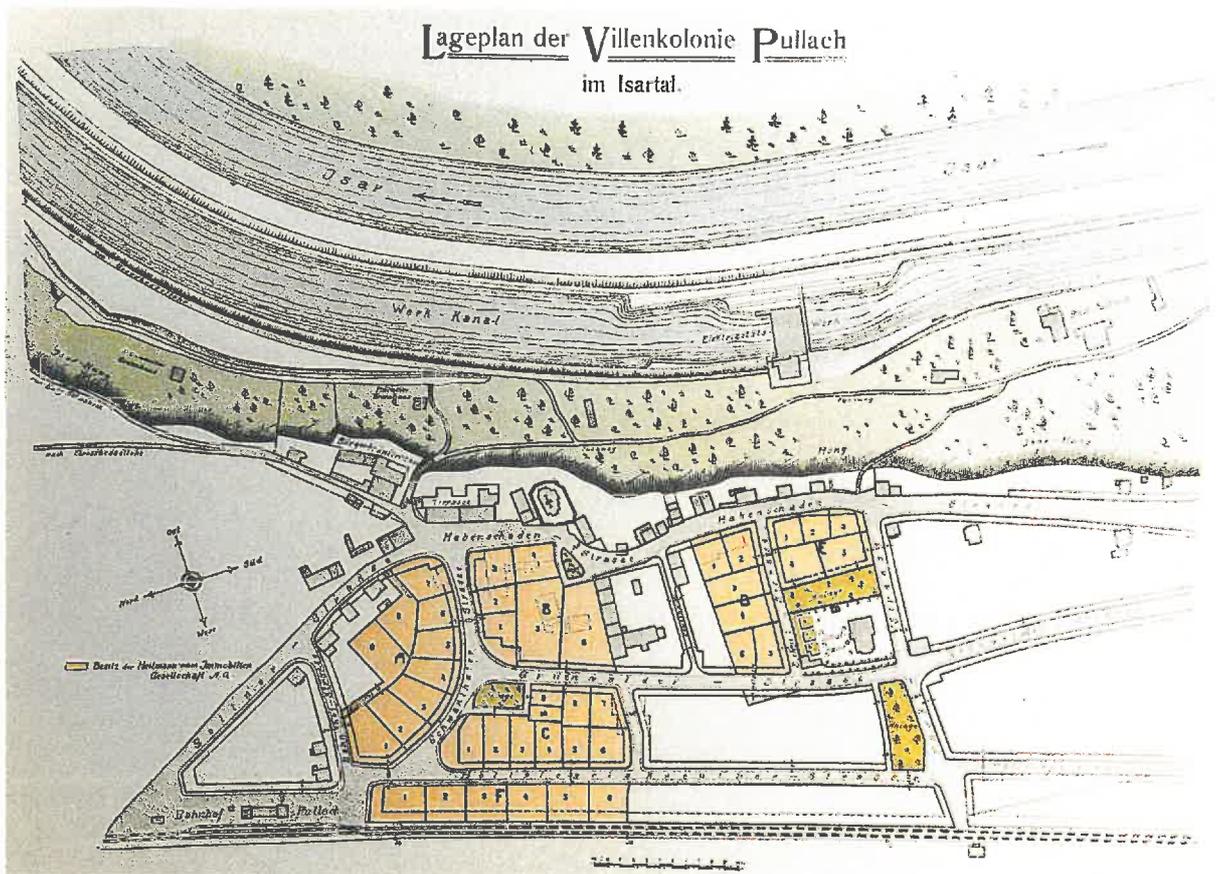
Lageplan der Villenkolonie Pullach, 1907
